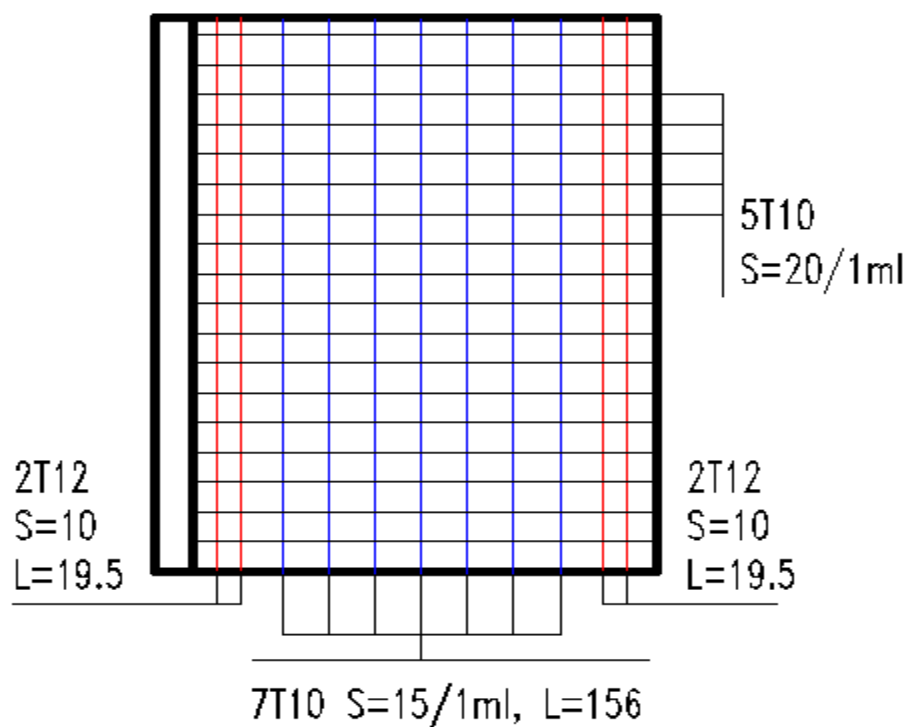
Coupe verticale pour le ferrailage d'un voile.
